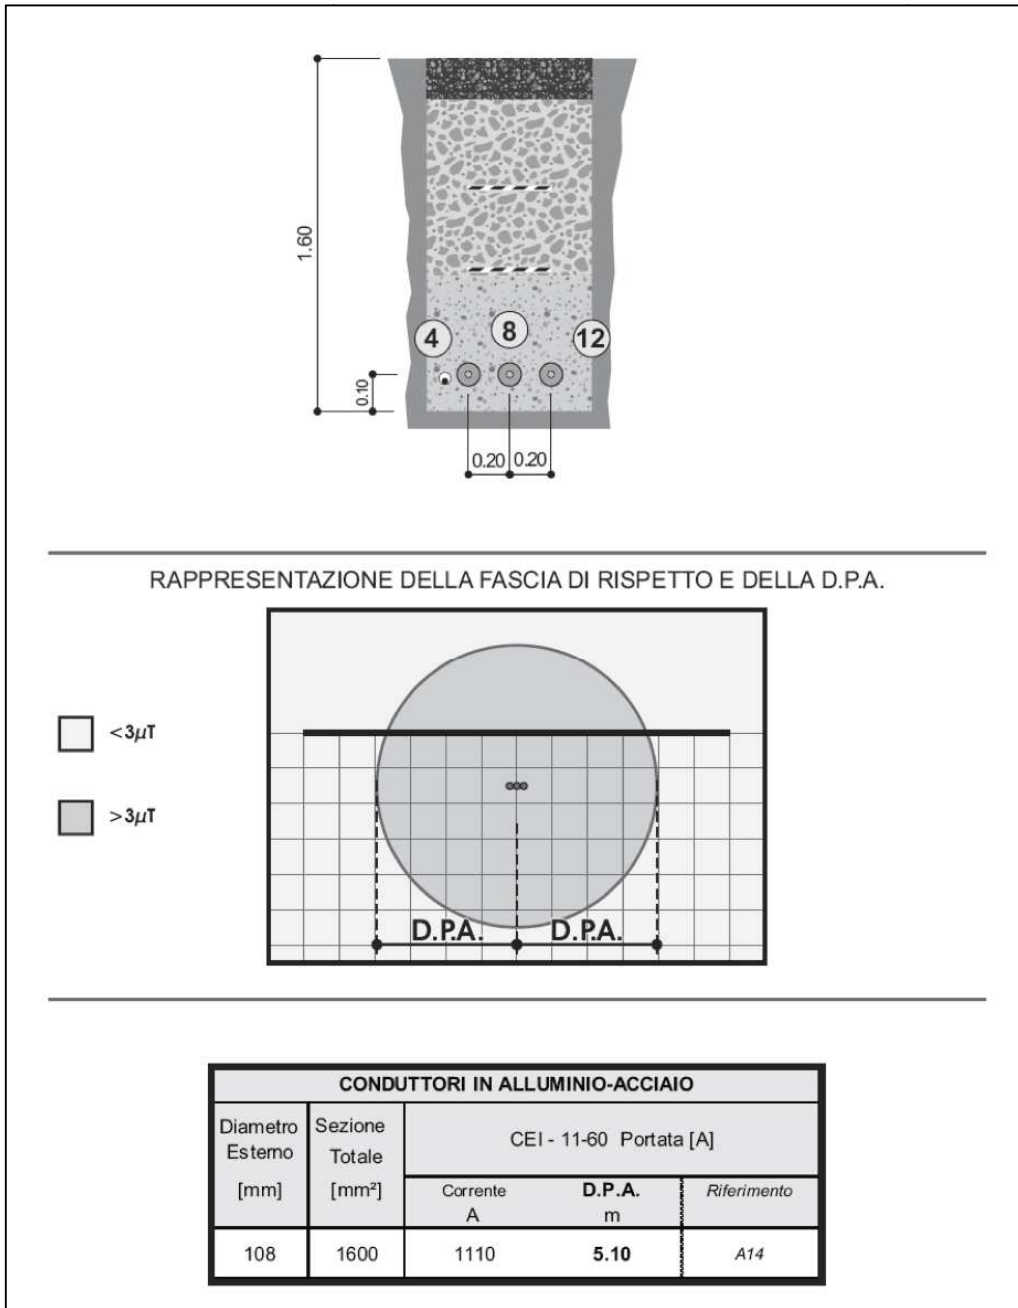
Rappresentazione della fascia di rispetto D.P.A. per cavi interrati disposti in piano
